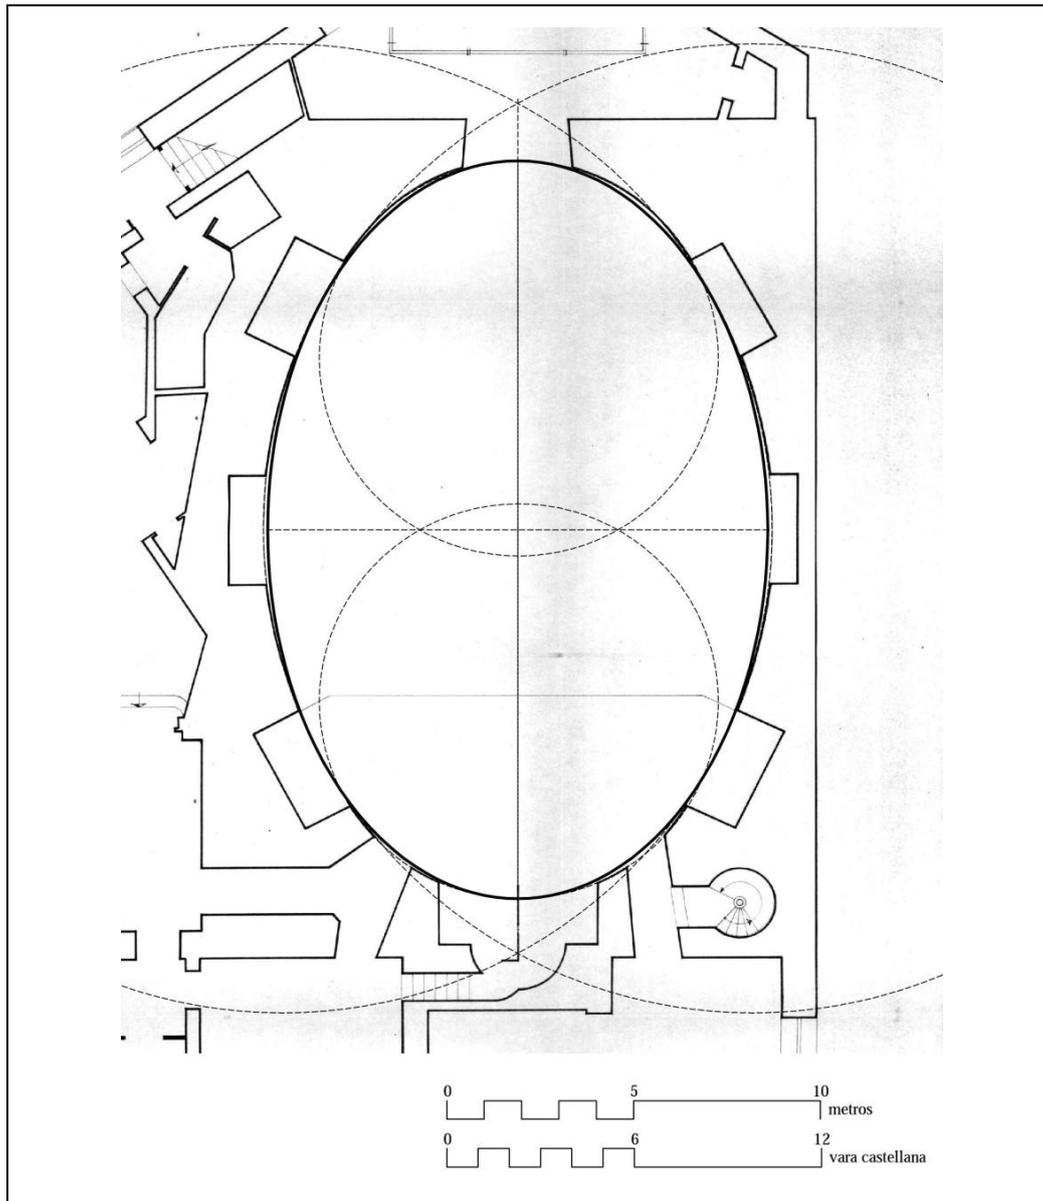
Planta obtenida sobre la Planta de Federico Prieto (1881).
